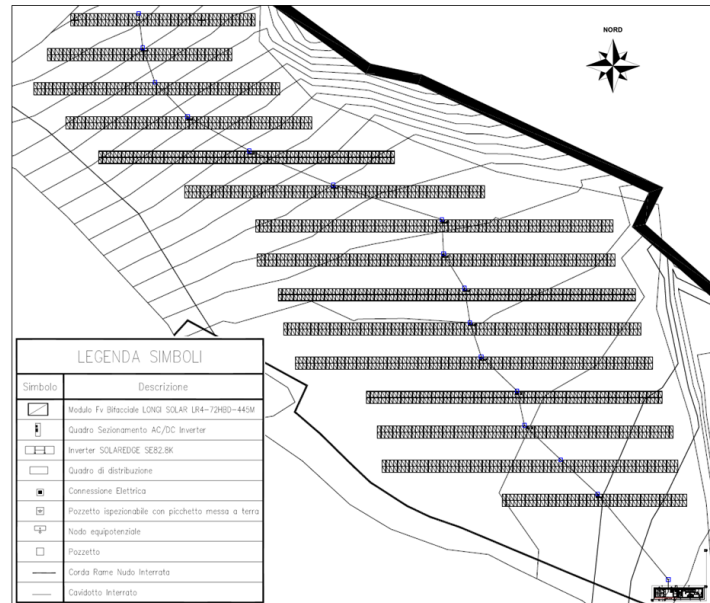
Estratto da Tav.E05.0 – Progetto preliminare, Planimetria 1 Dettaglio impianto.
